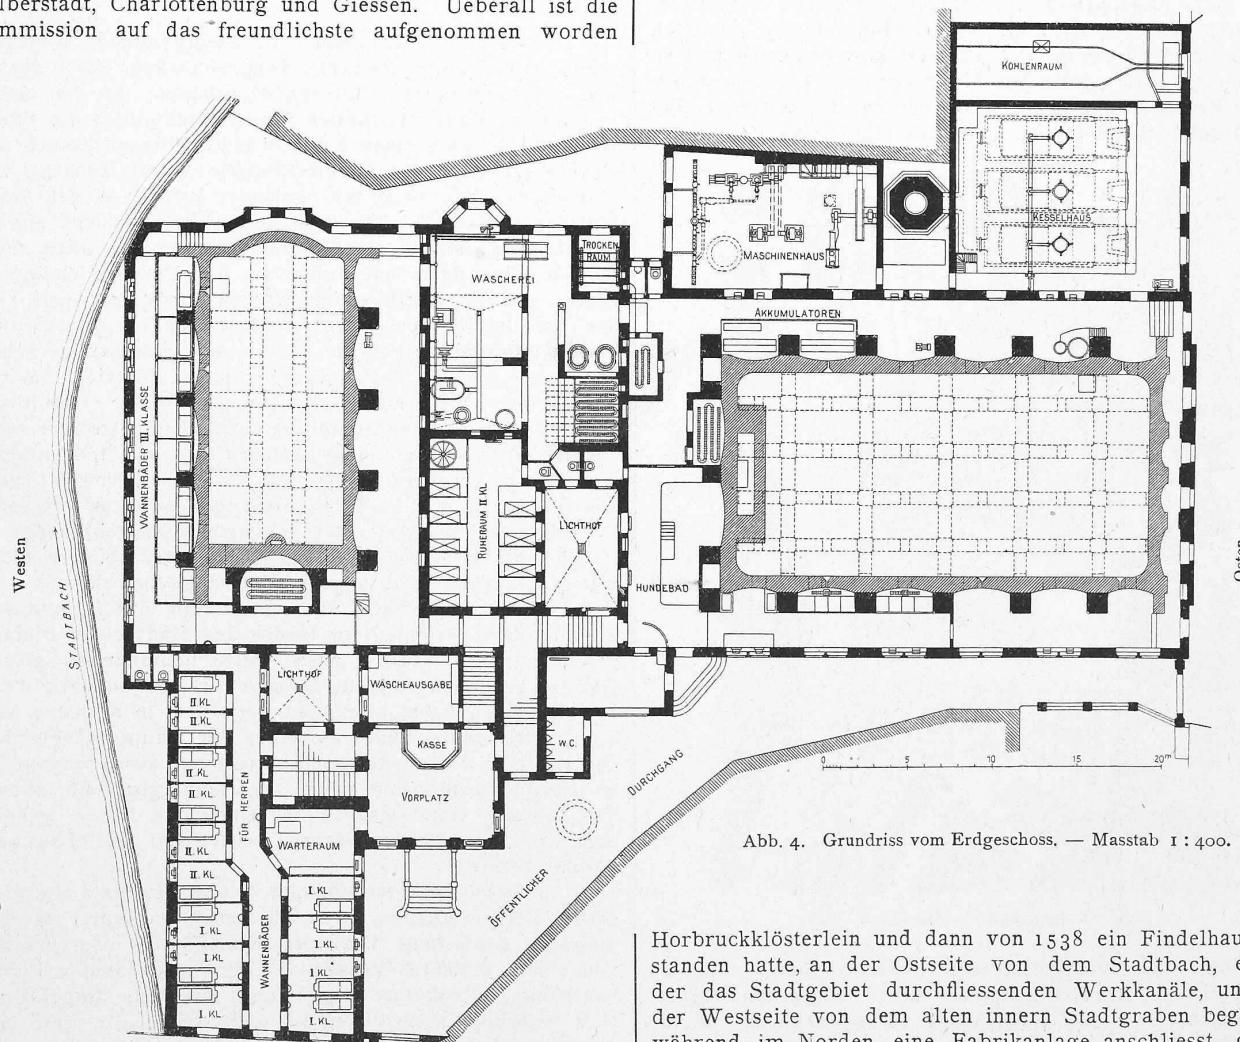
Grundriss vom Erdgeschoss. — Masstab 1:400.
